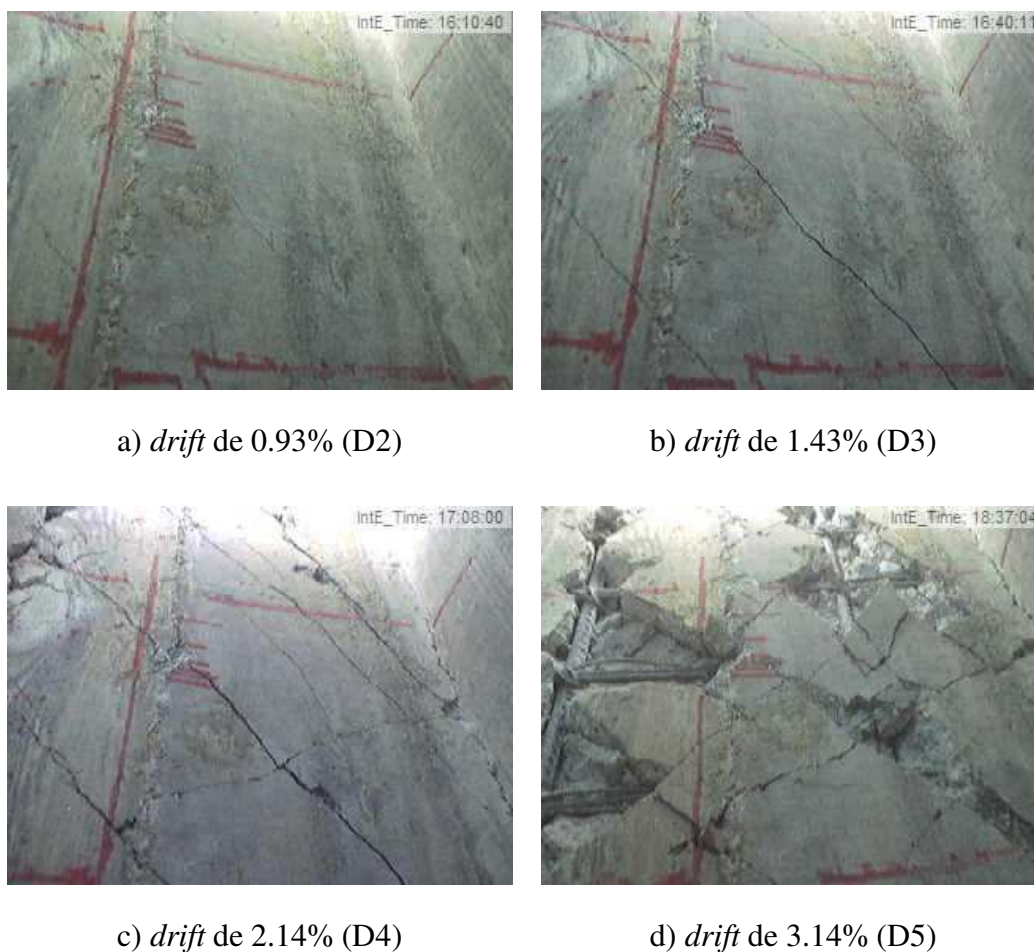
Danos nas faces interiores do pilar PO1-N6
